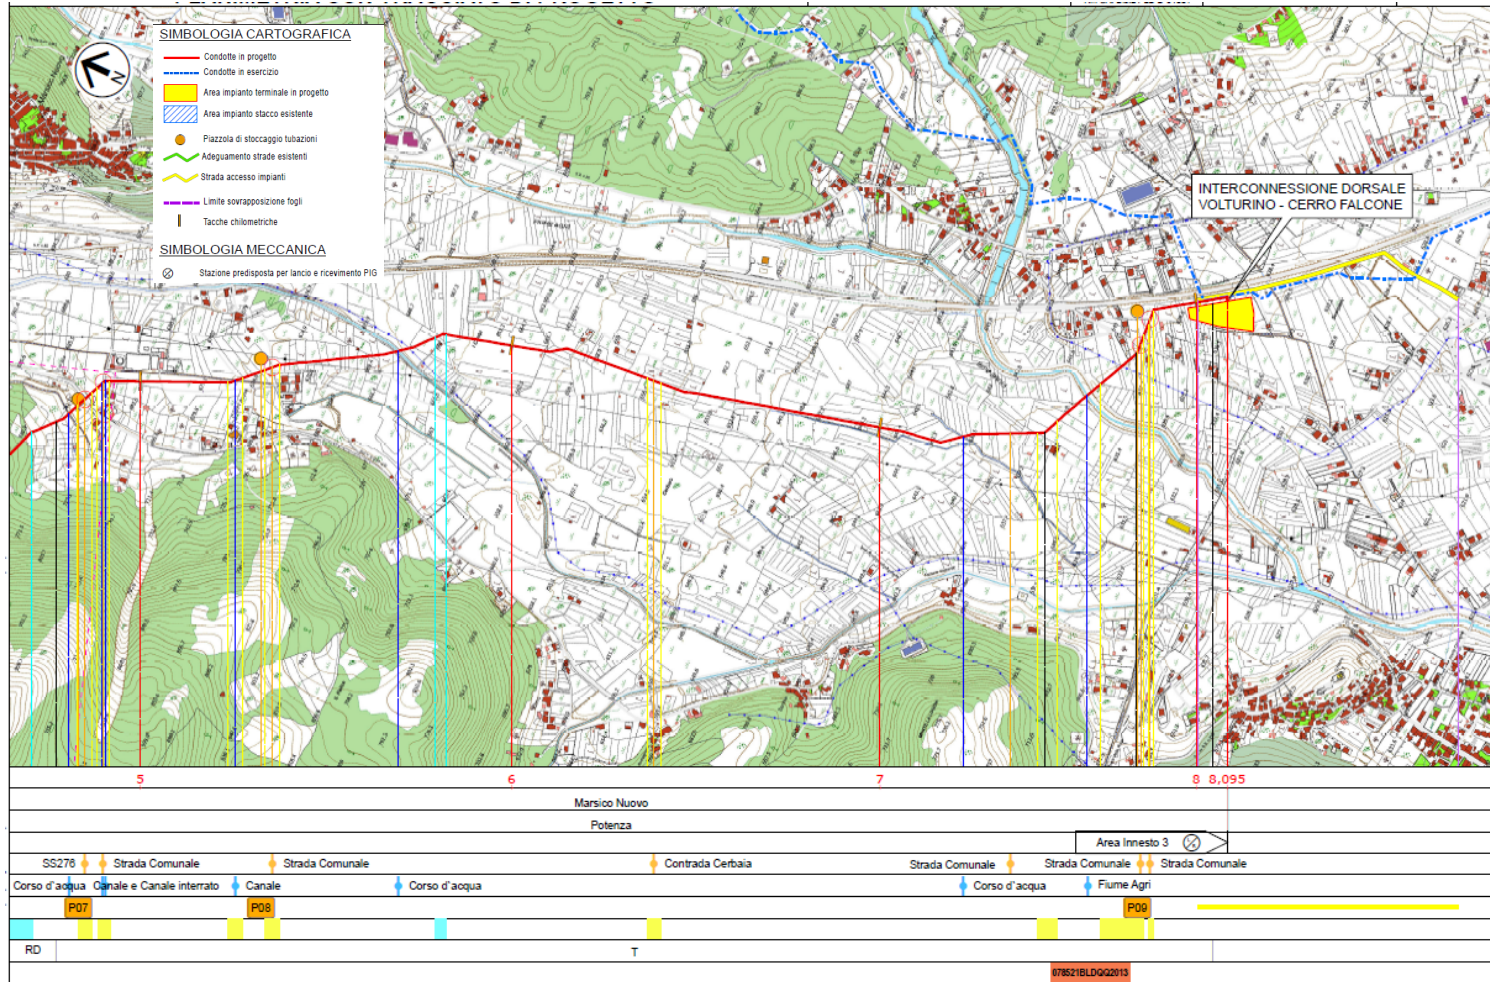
Layout cantiere ed ubicazione infrastrutture provvisorie (2 di 2)
